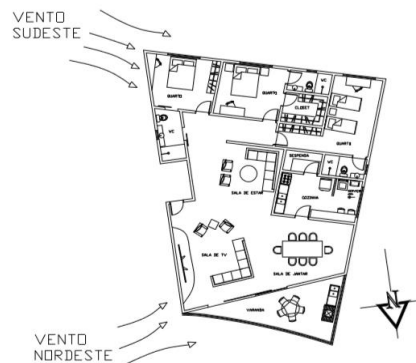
Planta baixa do apartamento tipo 1. Fonte: elaborado pelos autores.
